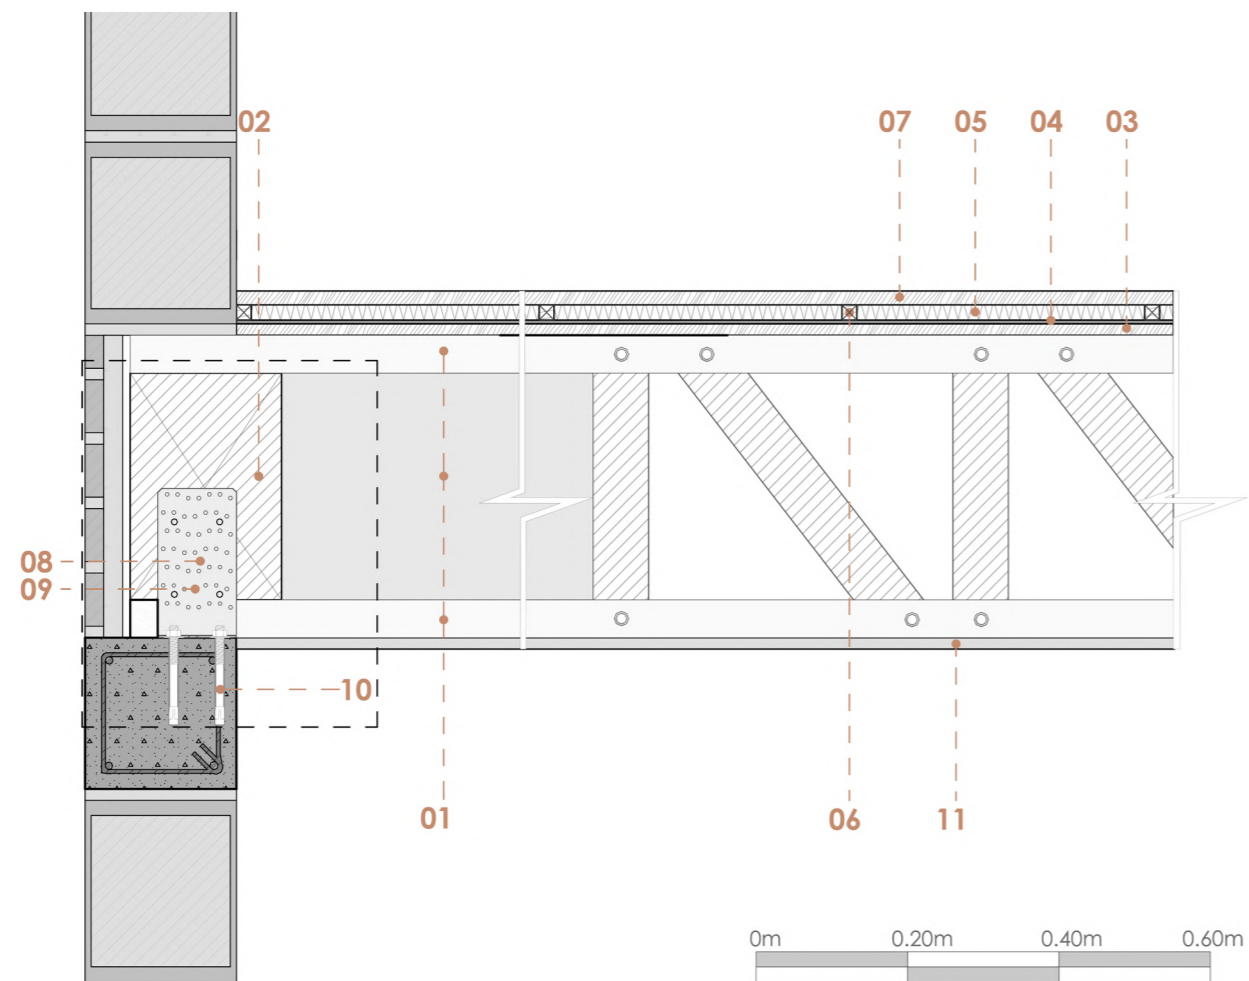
Detalle constructivo del entrepiso apoyado universal
